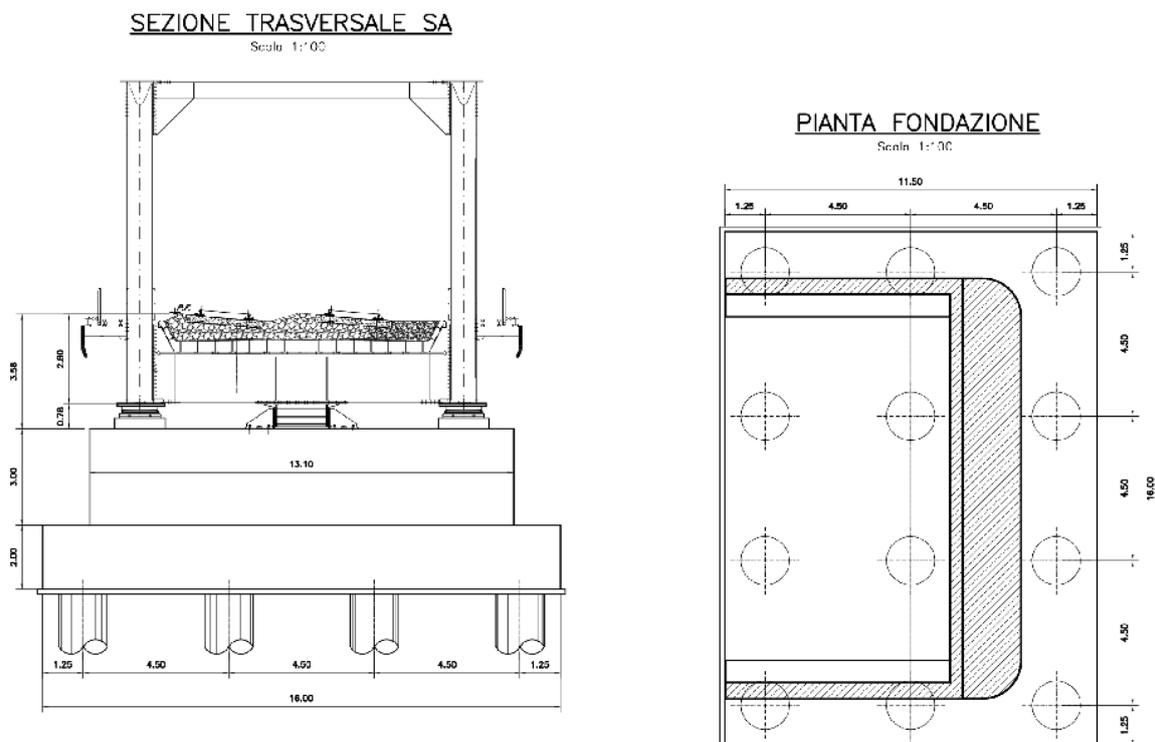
VI02 – Sezione su spalla A e pianta plinto di fondazione
